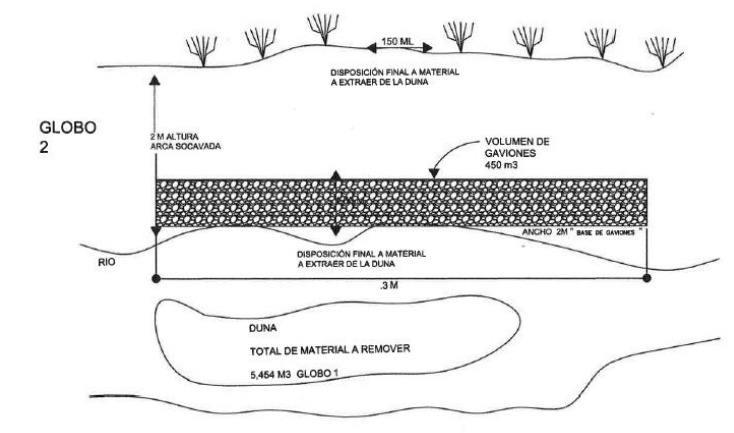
En esta imagen observamos el trabajo en el margen del cauce donde se colocarán los gaviones.
